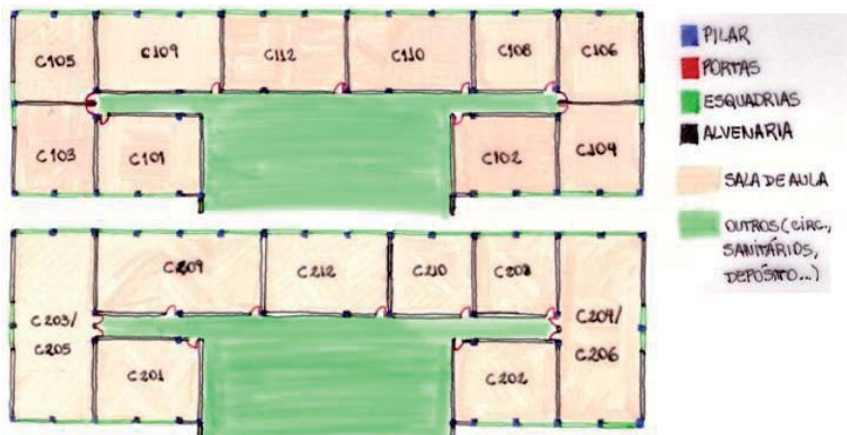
Croqui do Bloco C da IES, 1º e 2º pavimentos e salas de aula
